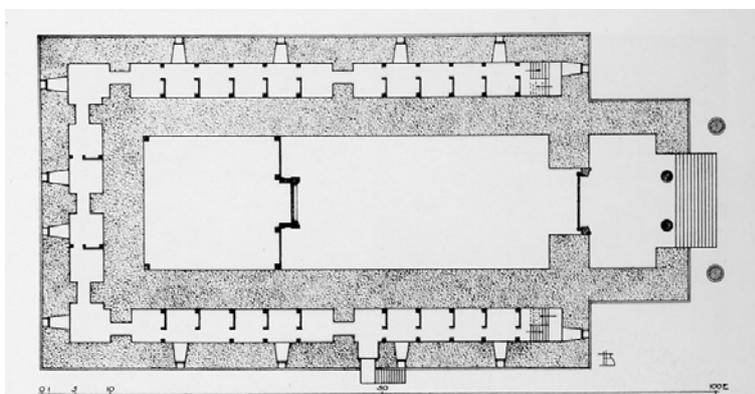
Tempelgrundriss mit dreigeteiltem Raum: Vorhalle, Hauptraum und Allerheiligstes
